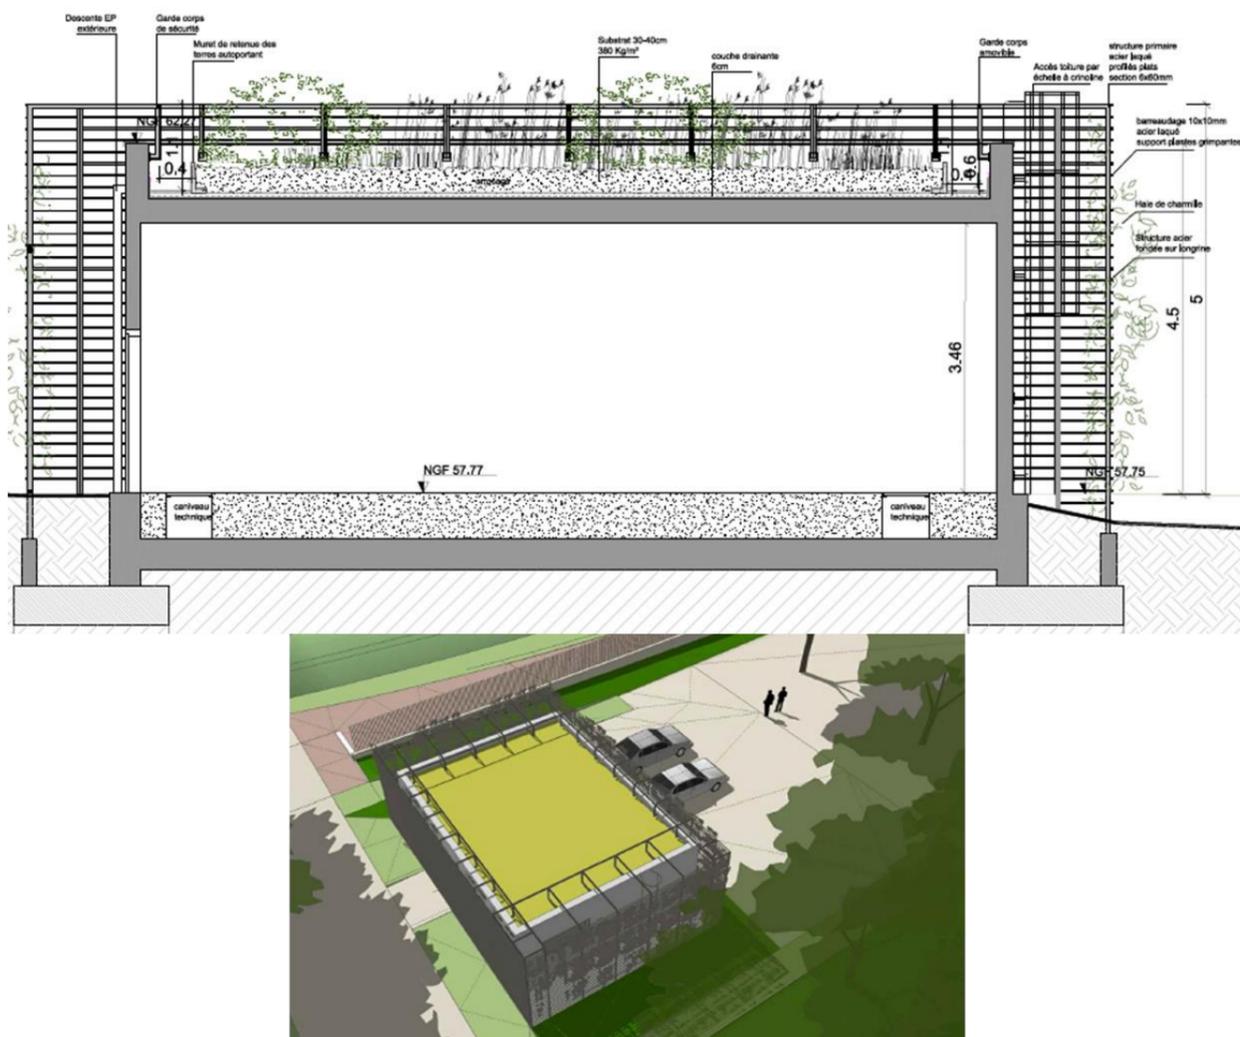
Illustration du site Parc – Coupe et vue générale, source : Études PRO – Groupement SARA
